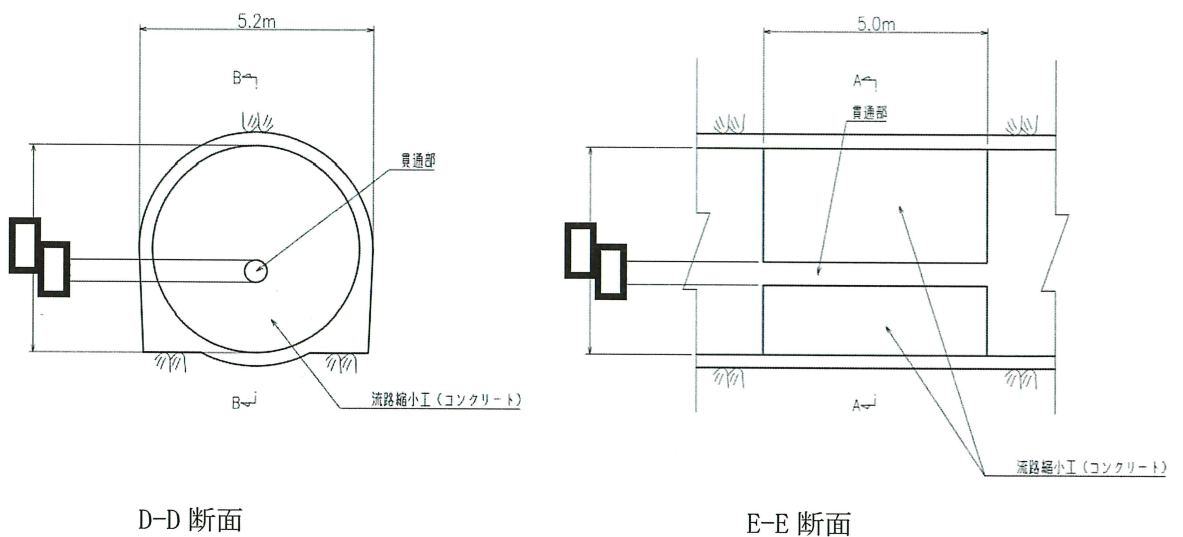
取放水路流路縮小工（第1号機放水路）の平面配置図
